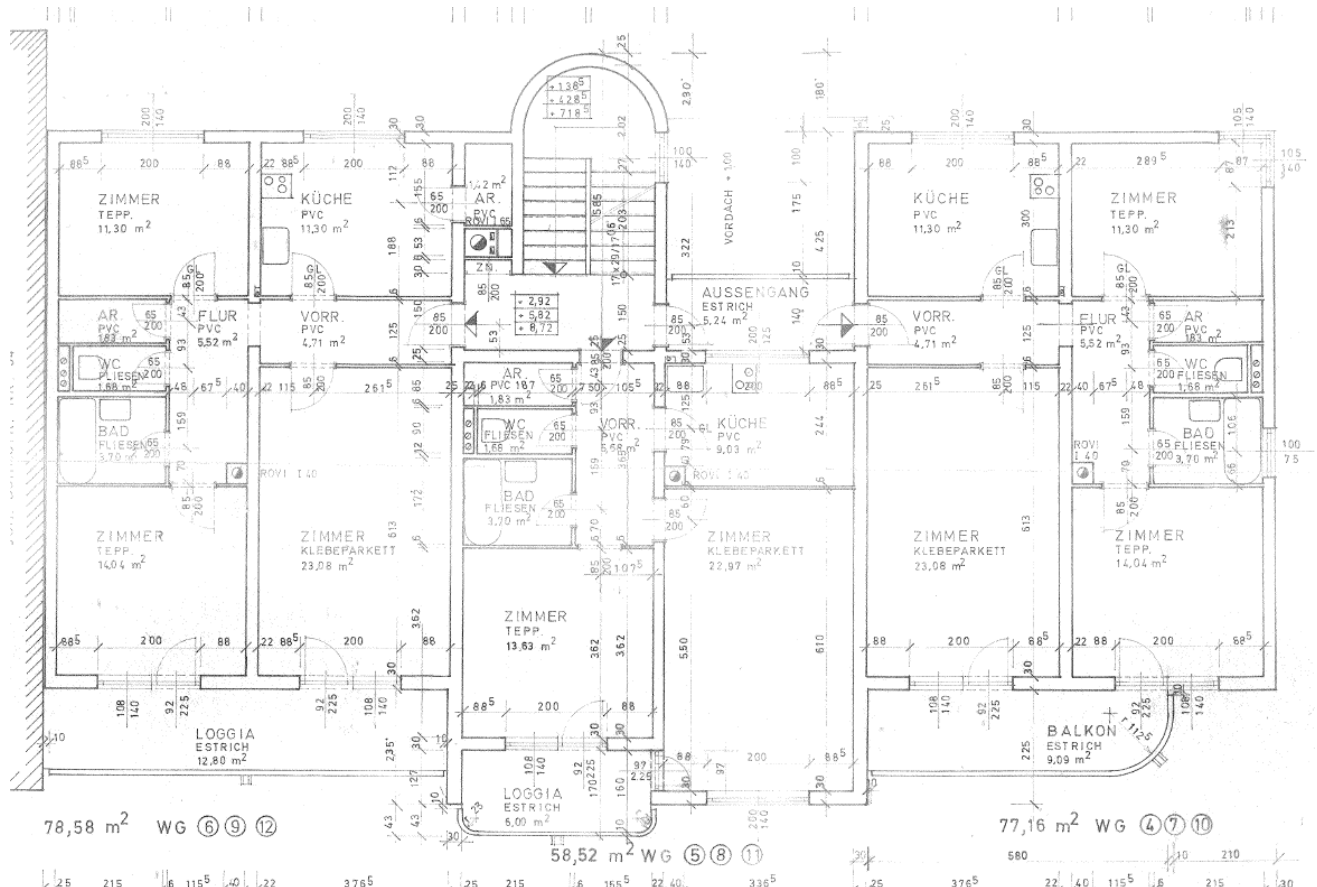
Plan: Grundriss 1.-3. Obergeschoss; Stand 09.12.1976
